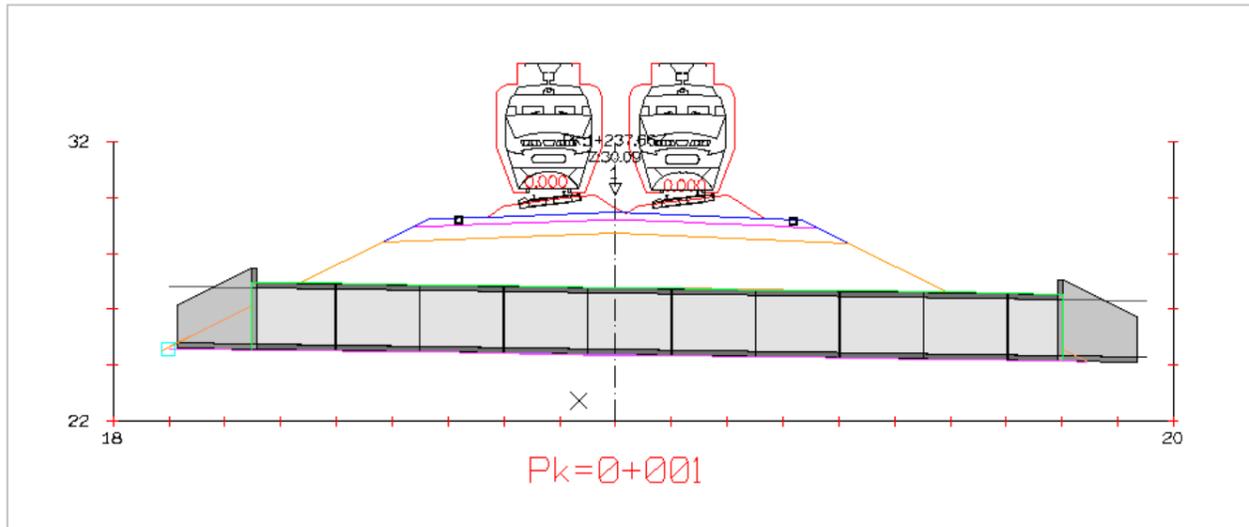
ODT del eje Mar-Gornazo en alzado. Fuente: Istram
